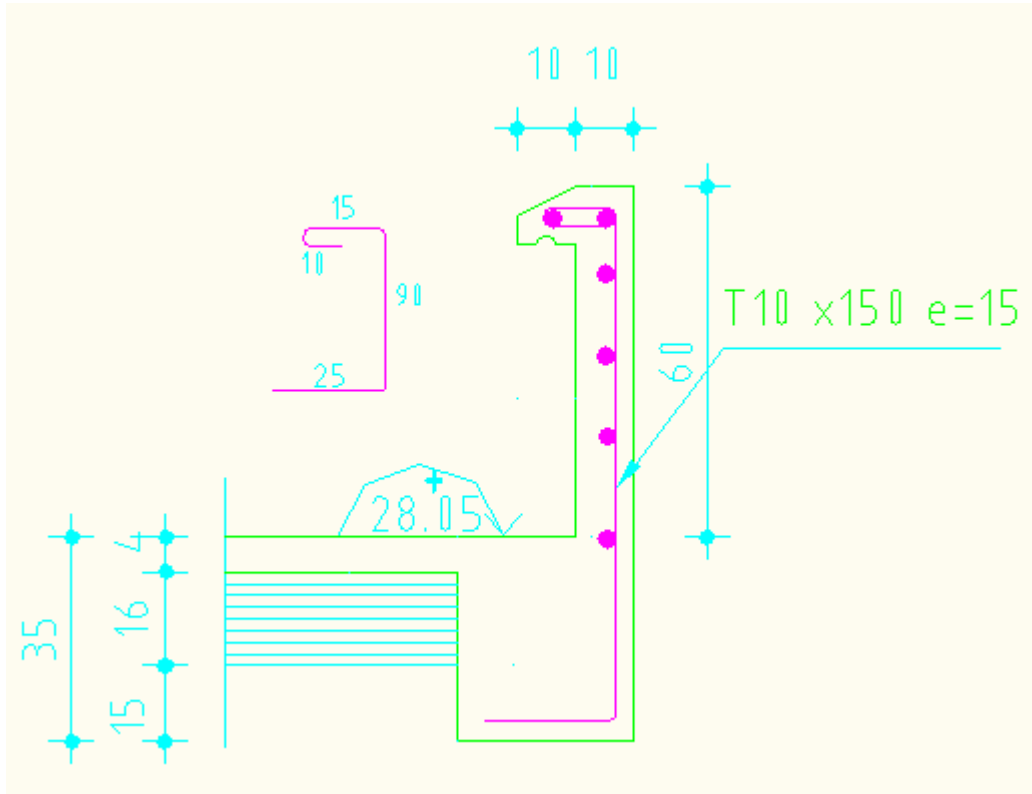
Schéma du ferrailage de l'acrotère.
